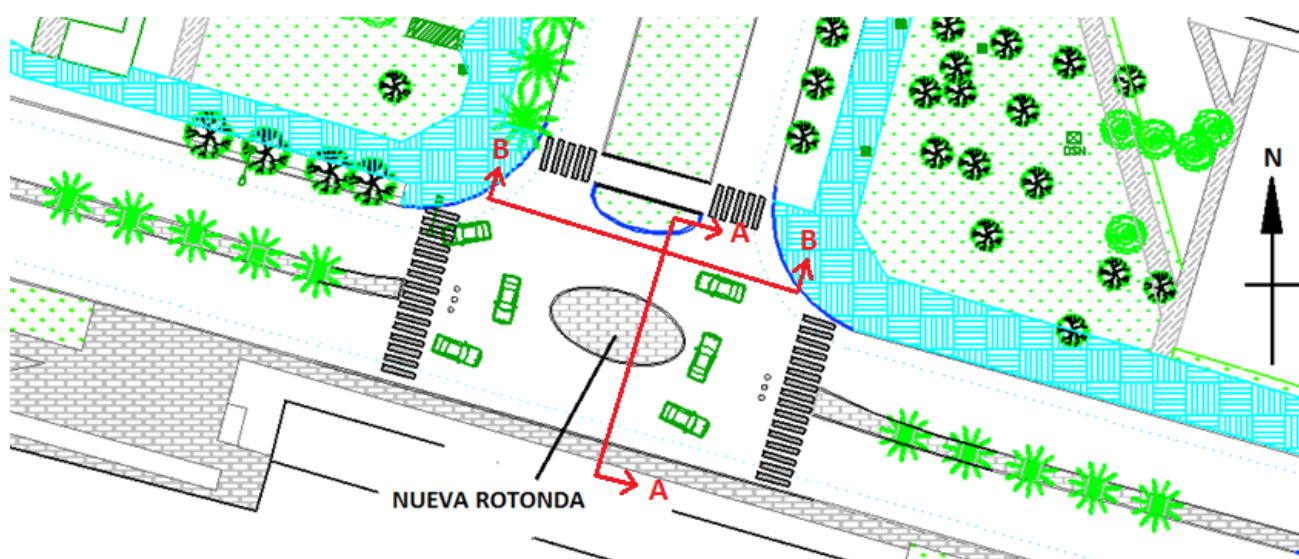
Rotonda proyectada en la intersección de las Calles de Convivencia
